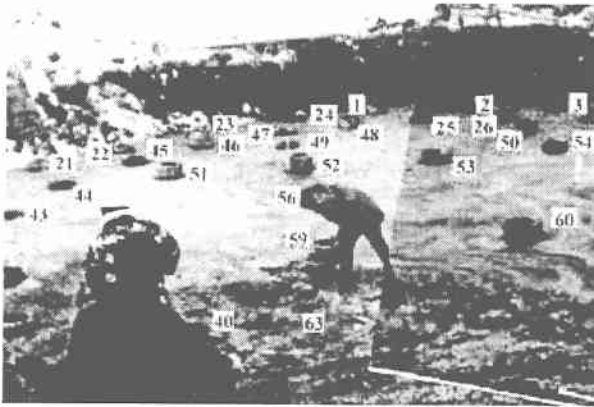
杭打設に続く捨てコンクリートを打設し、表面をならしている最中の施工写真 (1969.12.)
